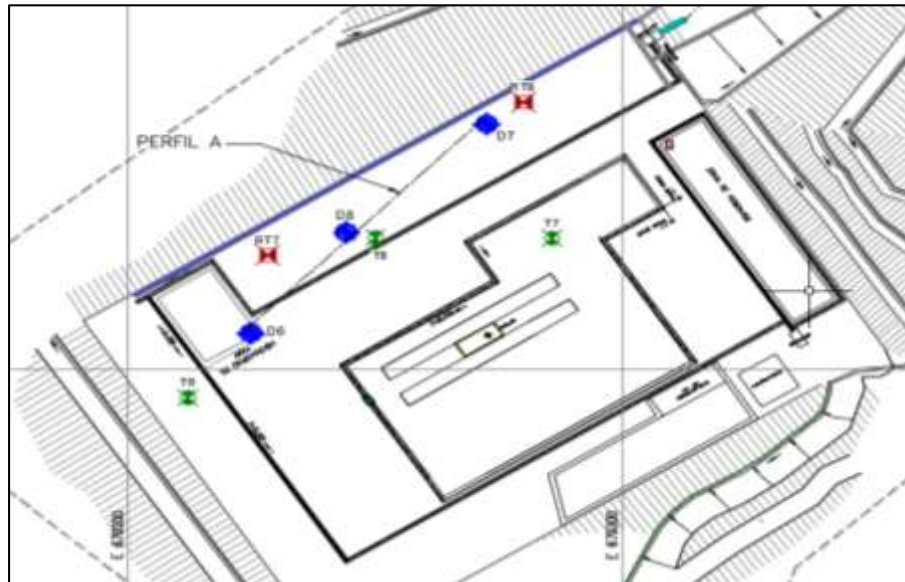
Ubicación de prospecciones en planta Sagari Bx.
